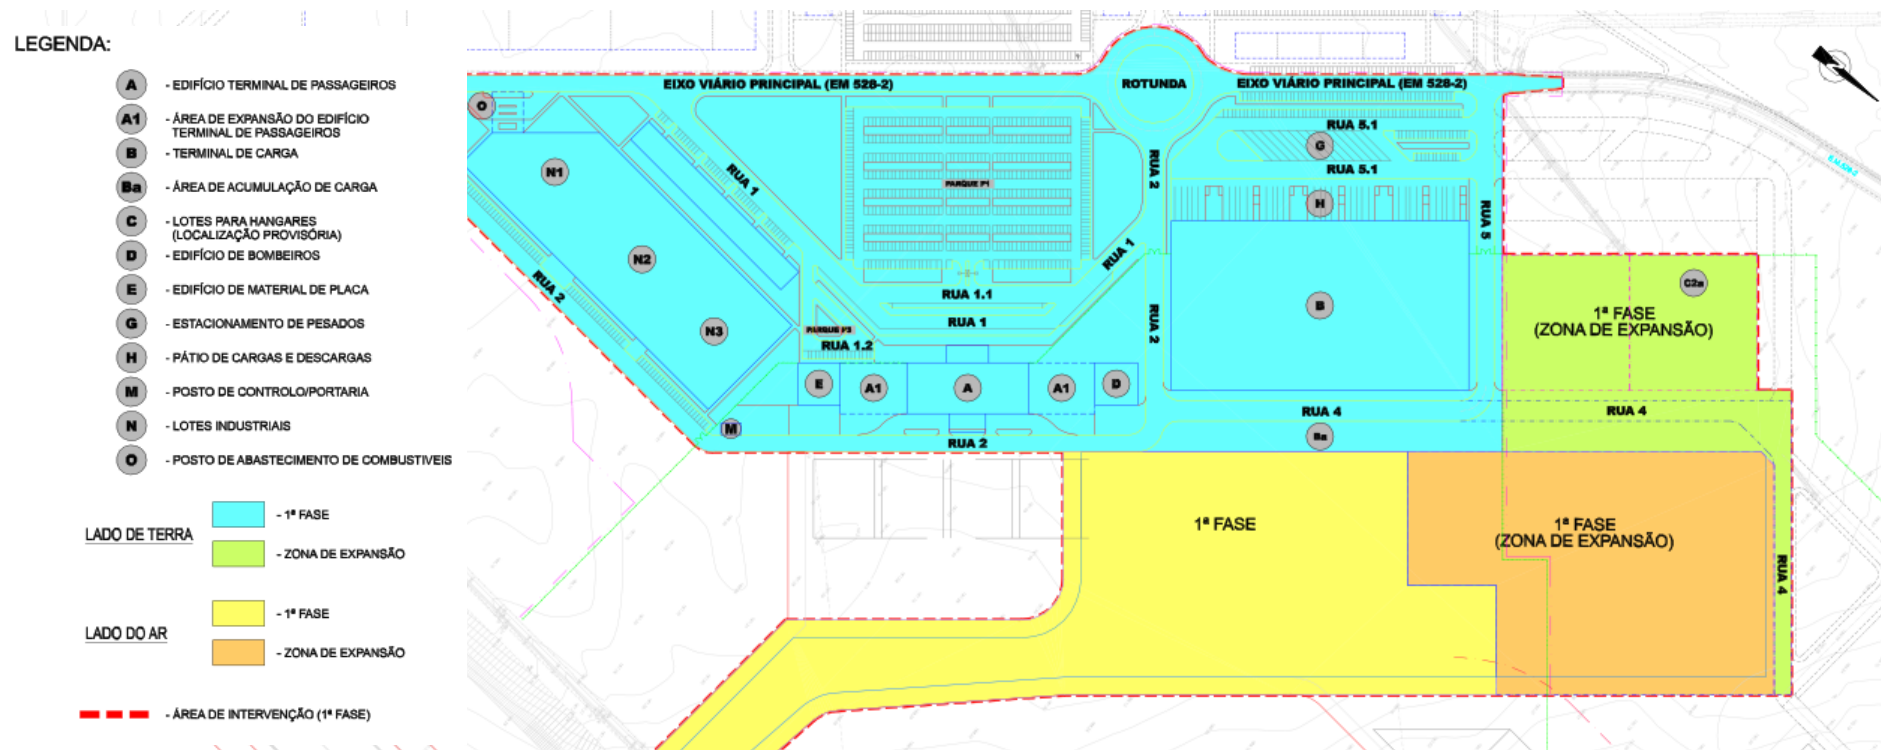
Planta da implantação da primeira fase do Aeroporto de Beja (COBA, 2004).
